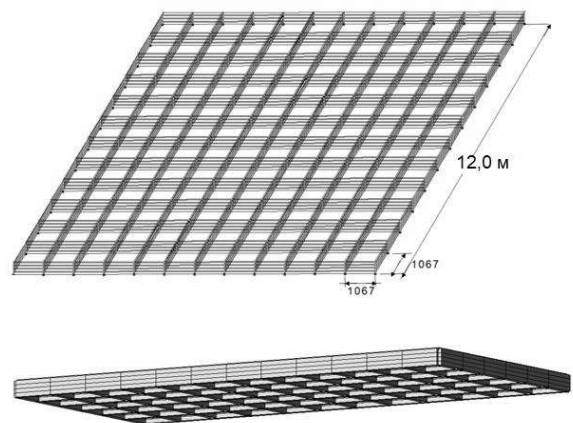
Модель №2 кесонного перекриття - з відкритими ребрами в нижній зоні – а; 3-D схема перекриття –б
